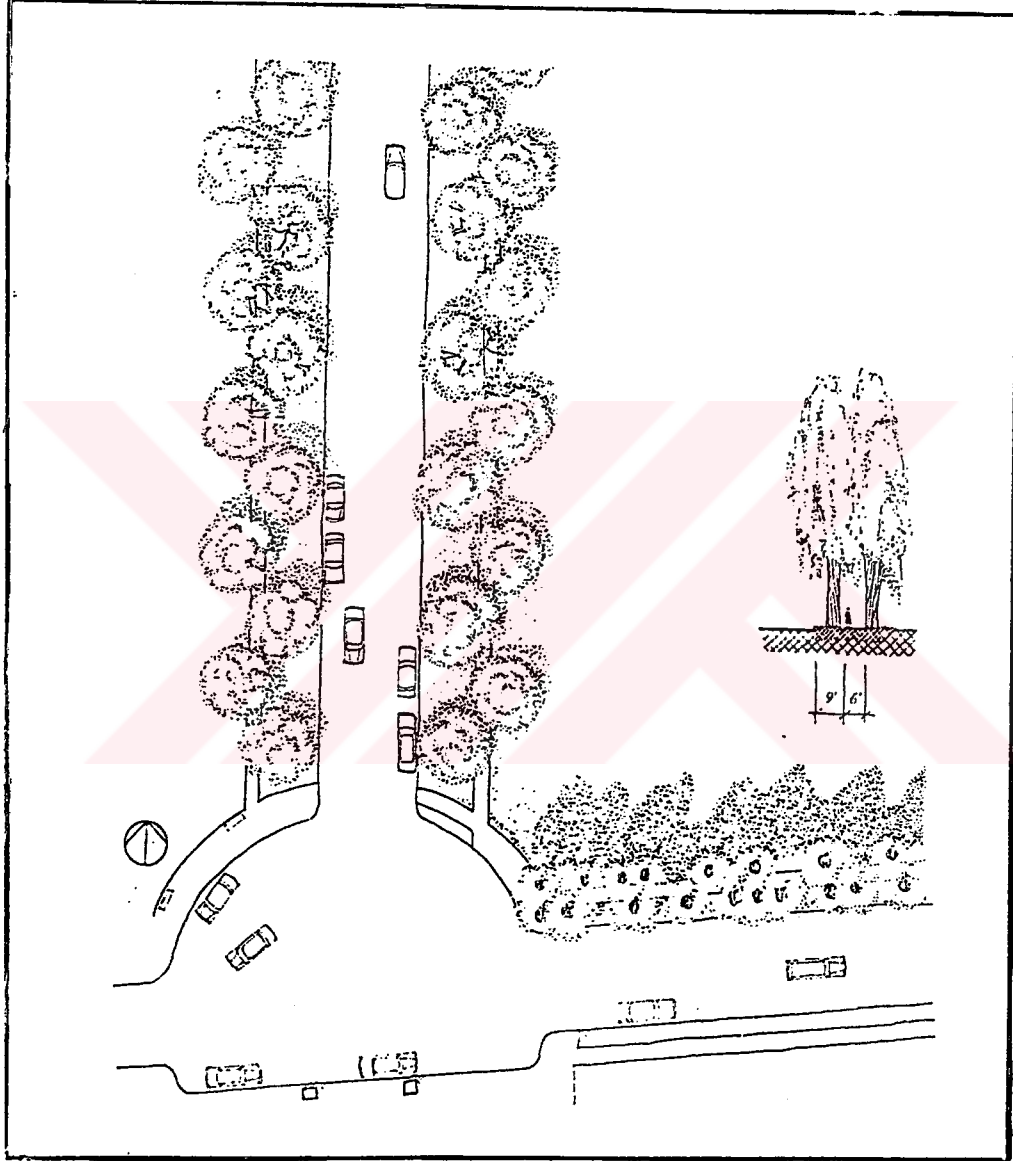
Monument Avenue Caddesi - Plan (Ölçek 1/600)
